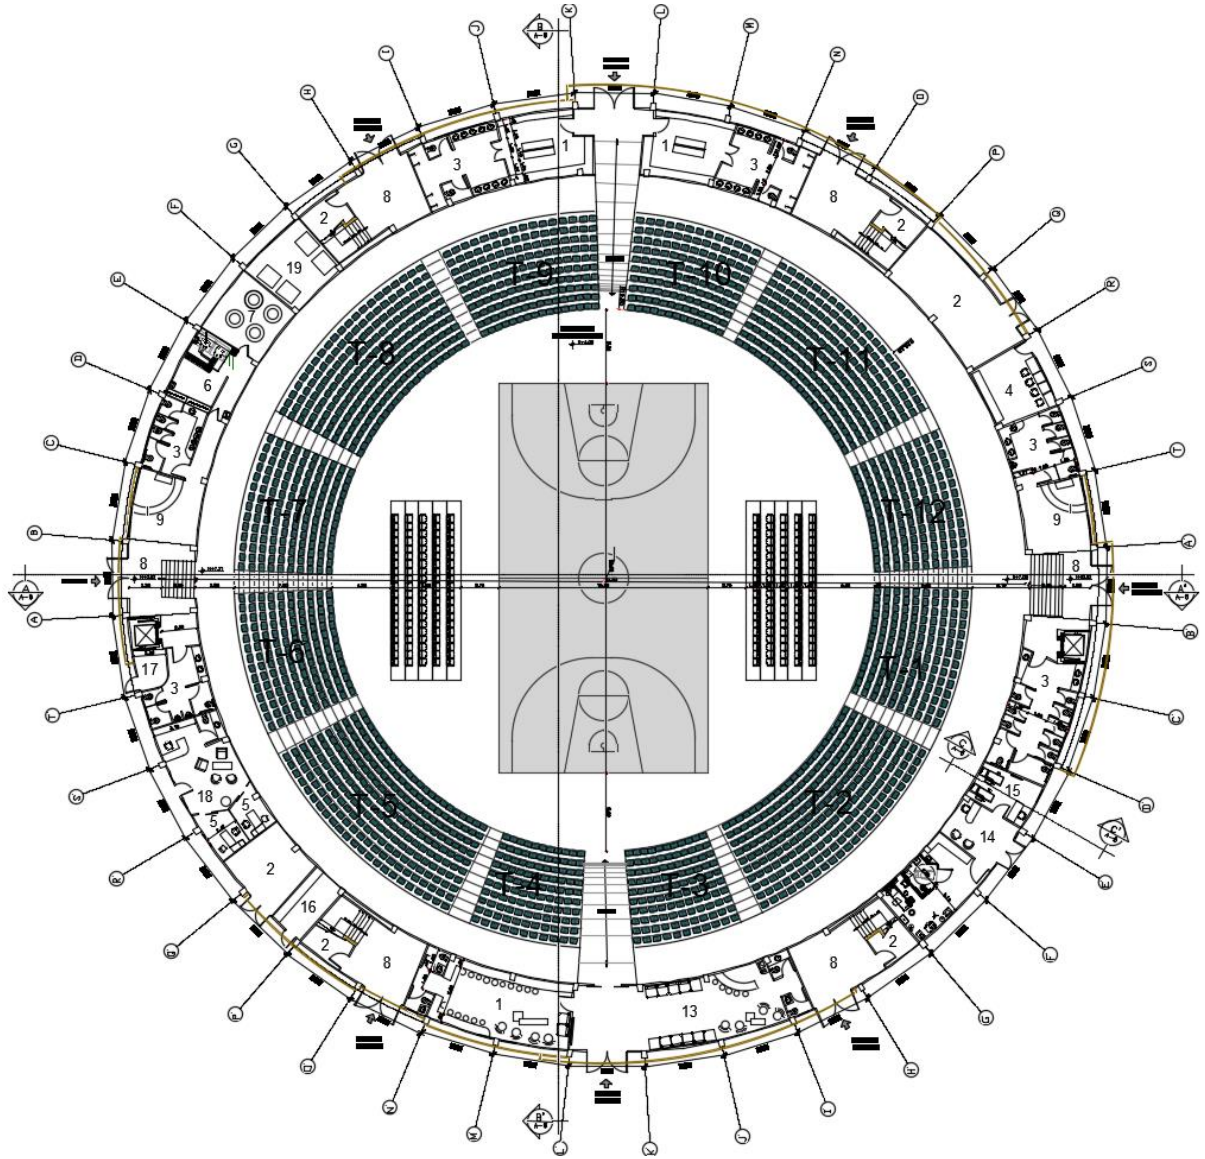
Planta baja derrocamiento. Fuente: Elaboración propia (2019).
